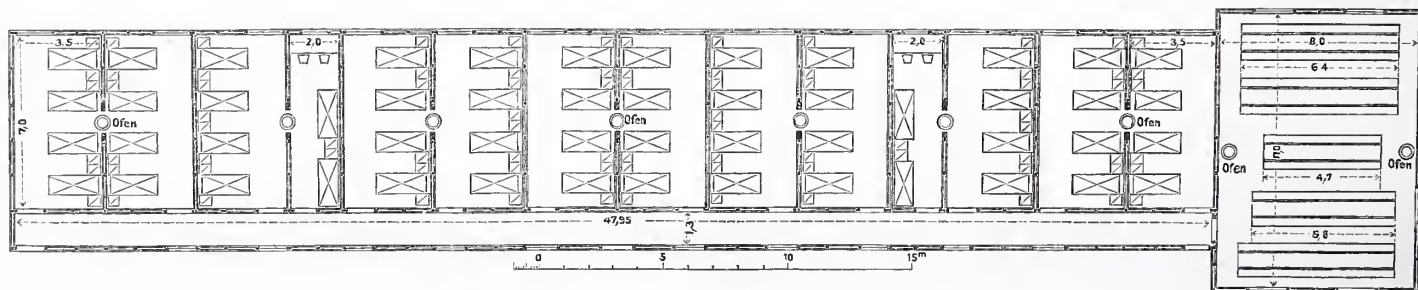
Grundriß einer Schlafbaracke für 100 Mann.
